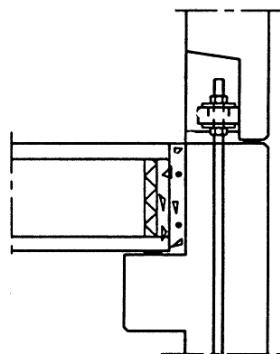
Ligação entre painéis de fachada através de aparafusamento e ligação à laje [33]
